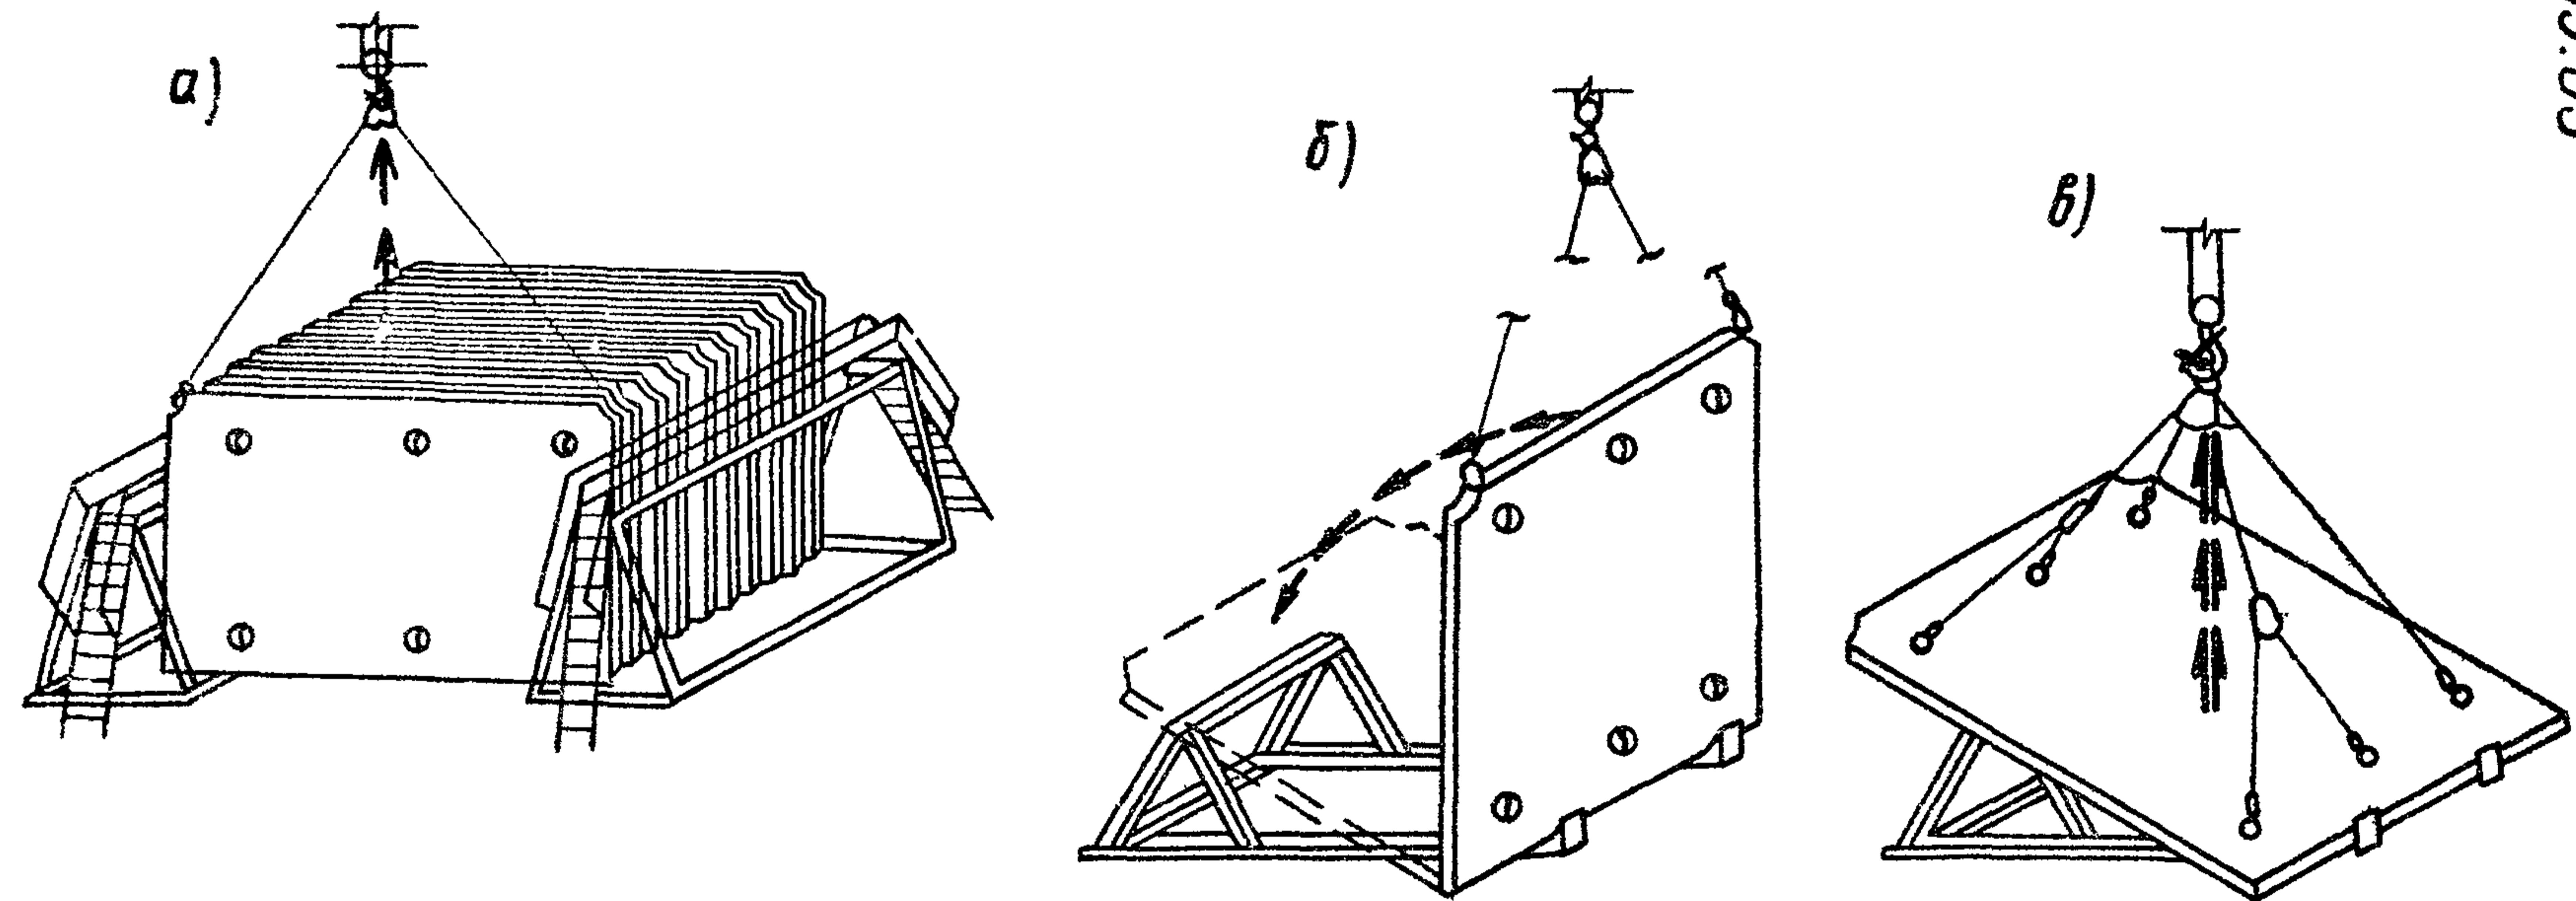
Последовательность перестроповки панелей перекрытия: а-подъем панели перекрытия из кассеты; б-контование панели перекрытия; в-перестроповка
